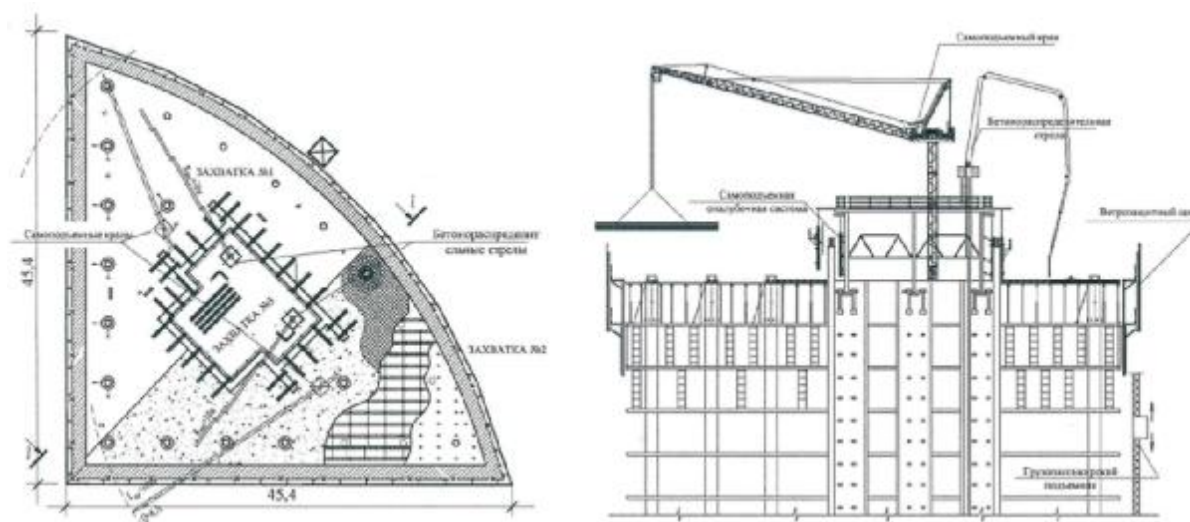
Технологическая схема производства работ по устройству трубобетонных элементов и перекрытий типового этажа
